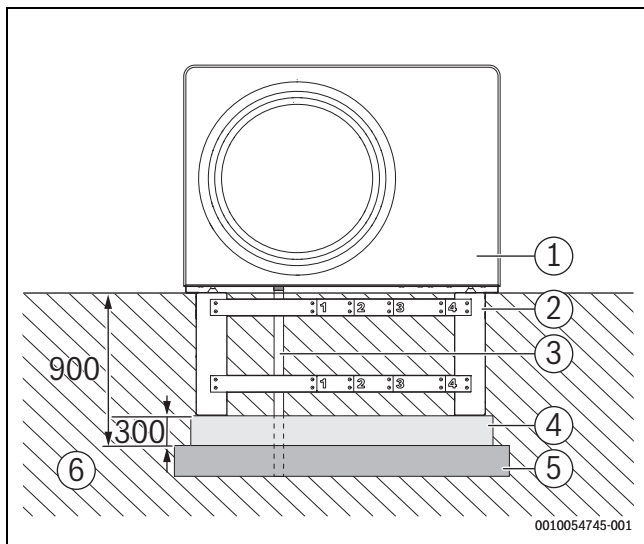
Exemple de mise en place : fondation préfabriquée dans le sol
